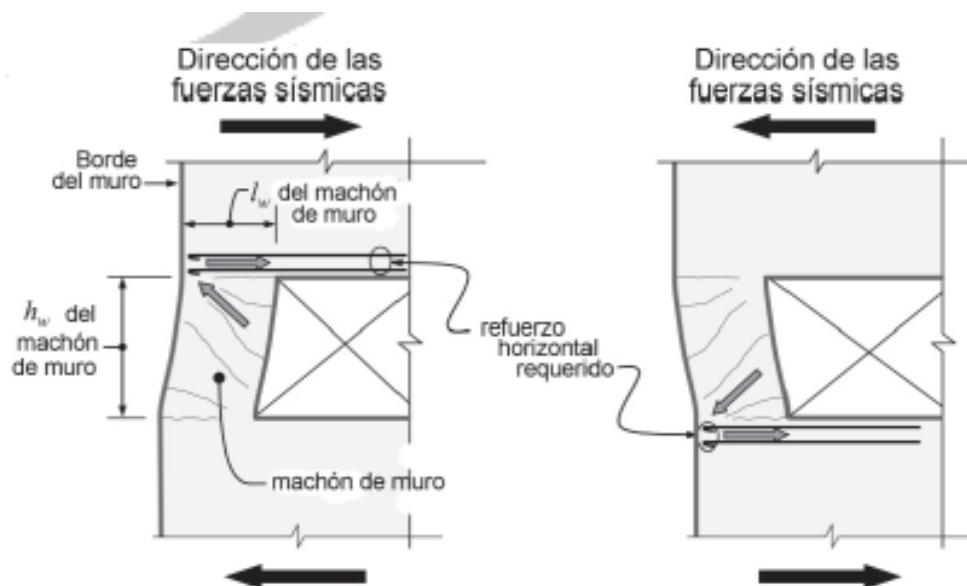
Refuerzo horizontal requerido en segmentos de muro por encima y por debajo machones de muro en el borde del muro.
